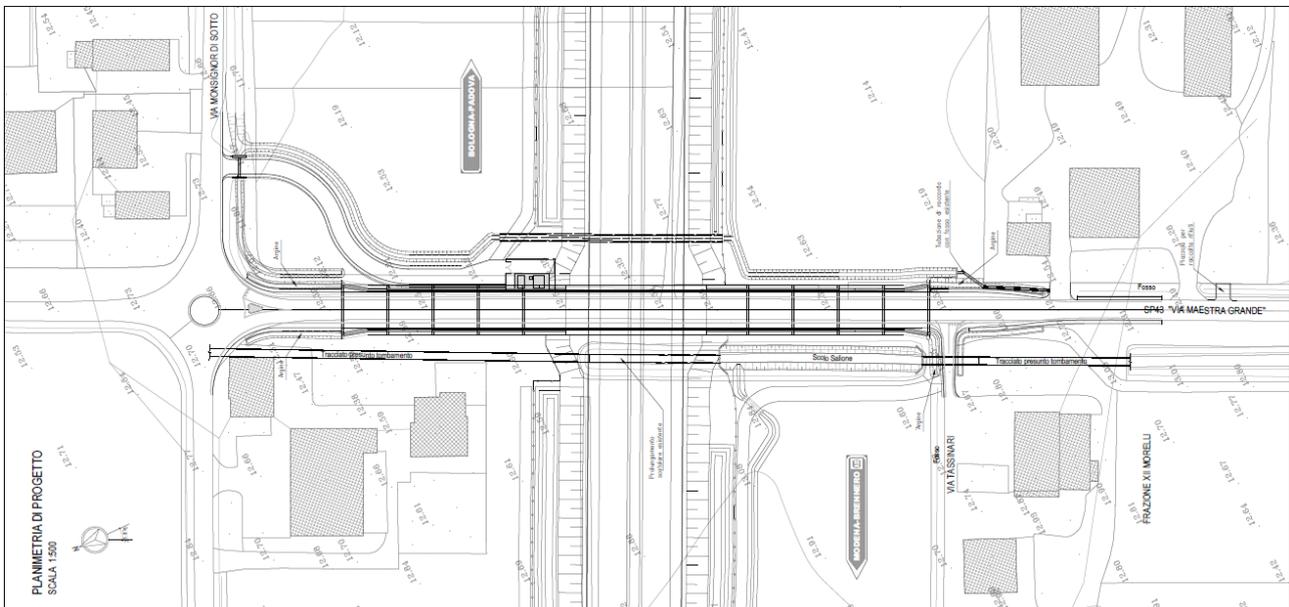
planimetria sottopasso S.P. 43 strada Maestra Grande
